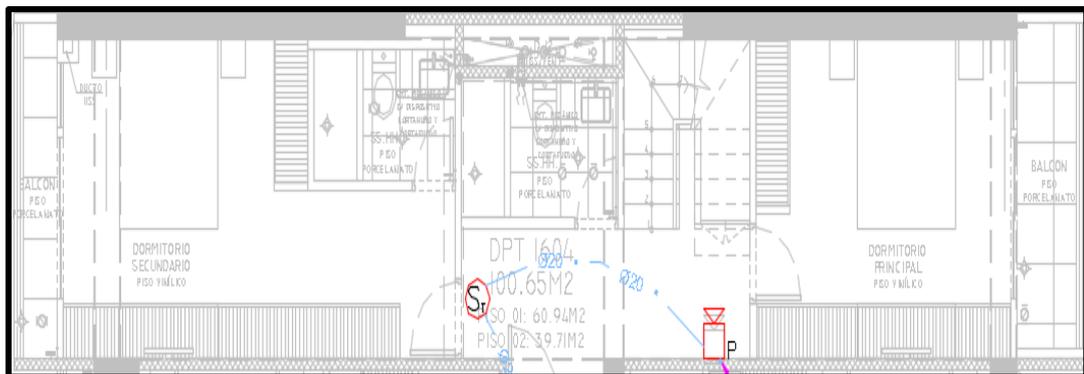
Equipos en departamento con 02 dormitorios 02 pisos (1° Planta)
